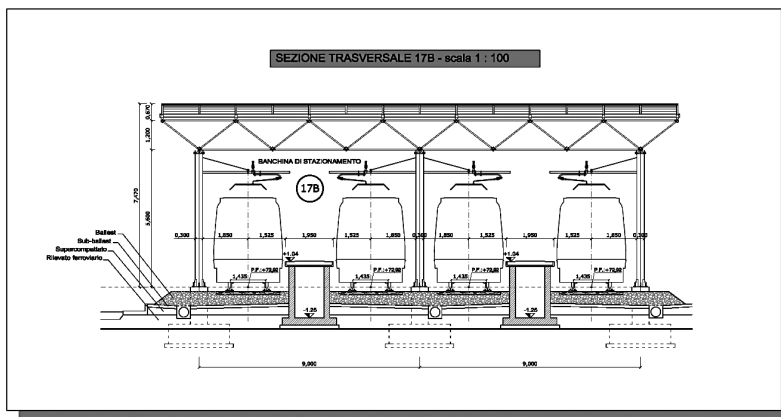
Sezione tipo dei binari nell'area rimessaggio treni.
